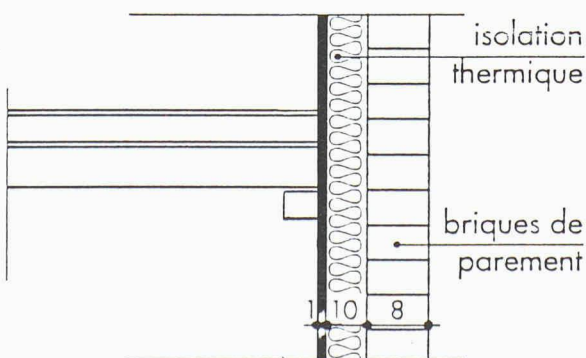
Coupe verticale d'un mur avec isolation extérieure et briques de parement
